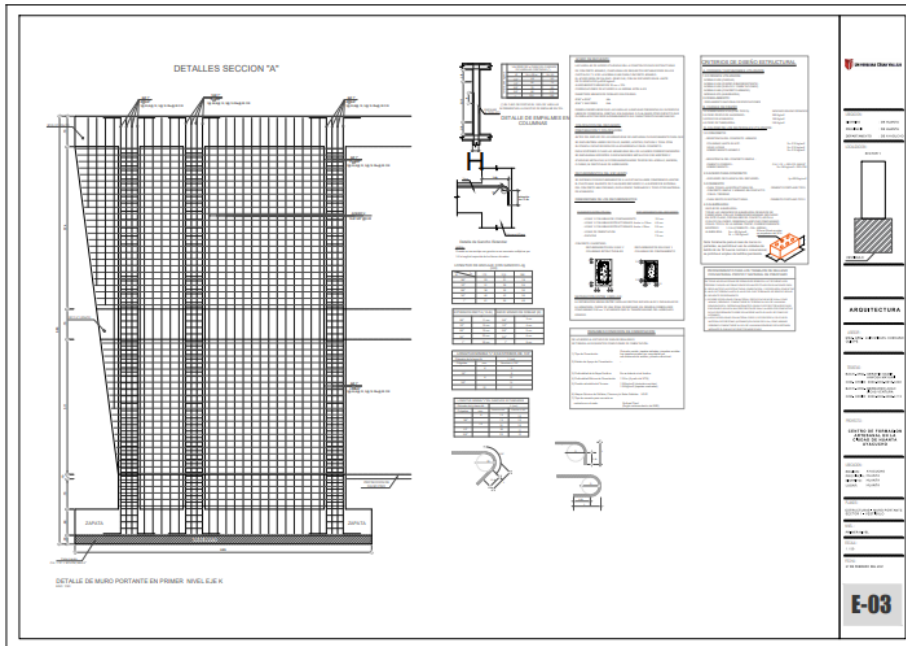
Plano de muro portante en el sector - escala 1/50.
